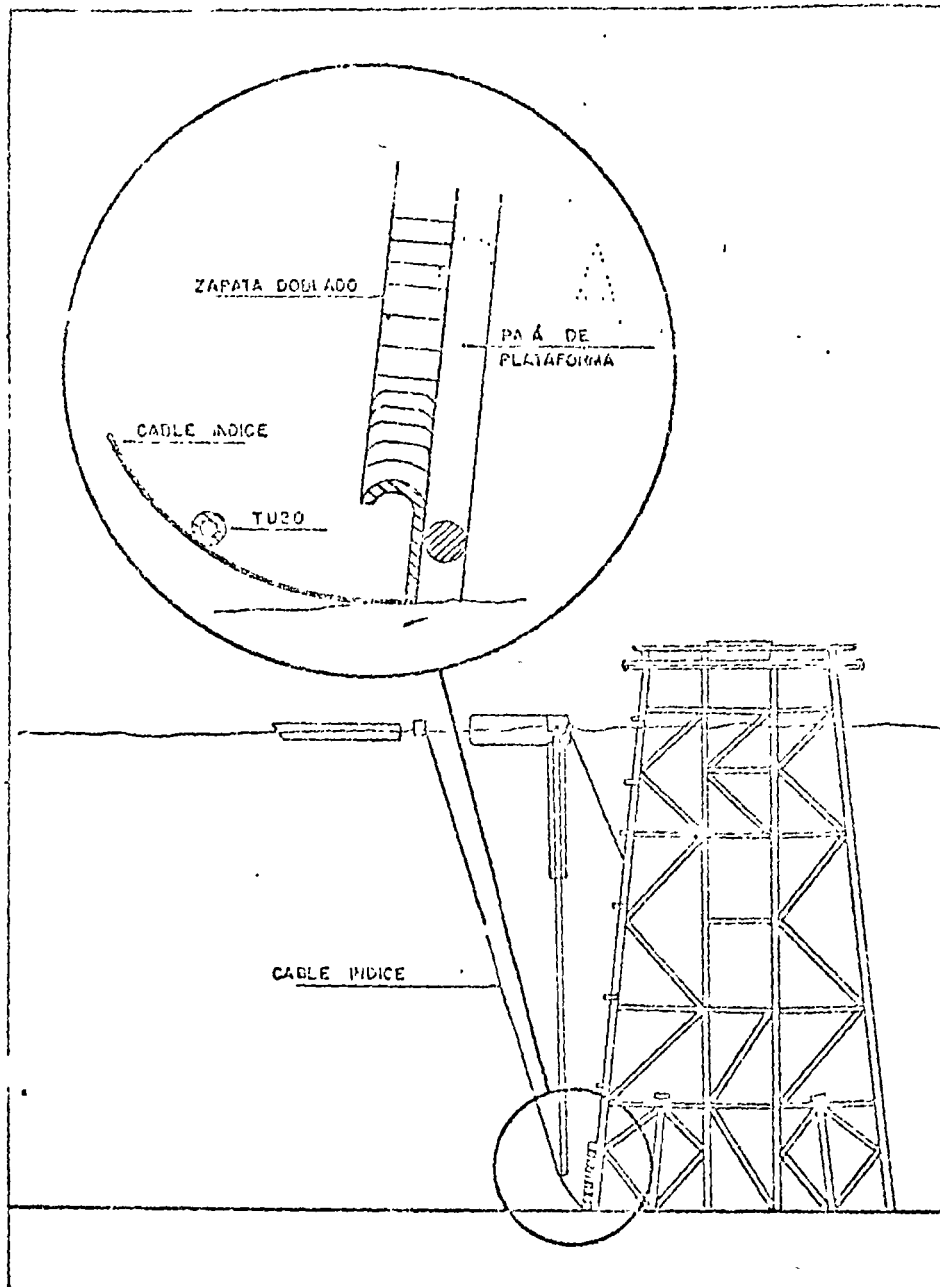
Dispositivo para colocar la tubería bajo la zapata de doblado
